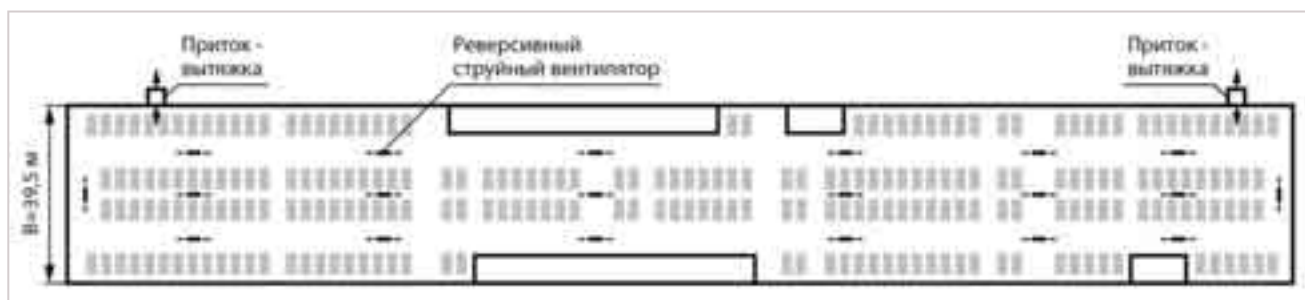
Схема расположения вентиляционных шахт приточной и вытяжной вентиляции в помещении автостоянки 10 000 м²
